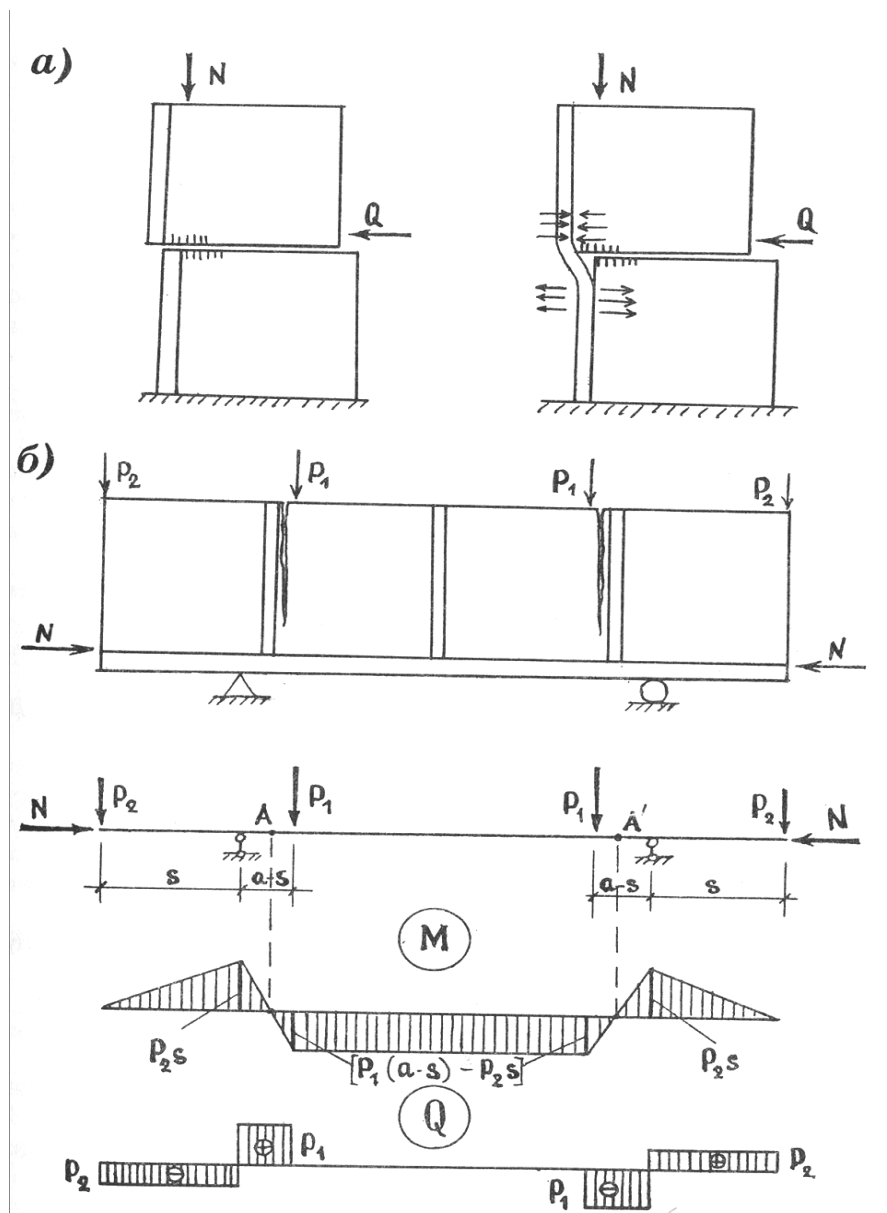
Испытание фрагмента тавровой бетонной стены на сжатие со сдвигом:
